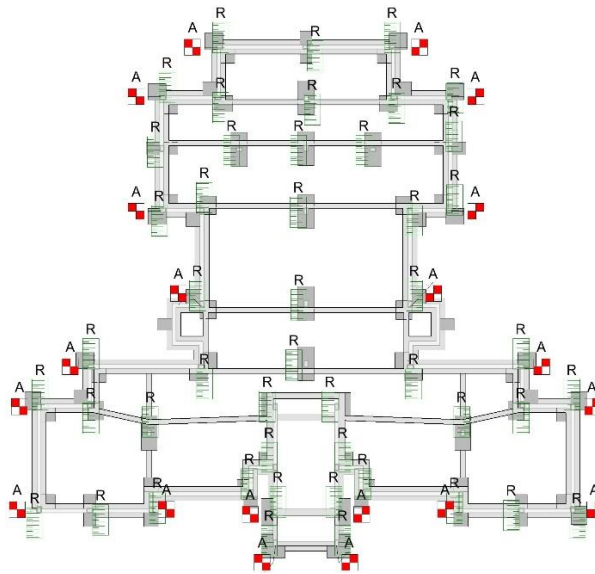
Instrumentação instalada no edifício no âmbito do plano de instrumentação e observação.
